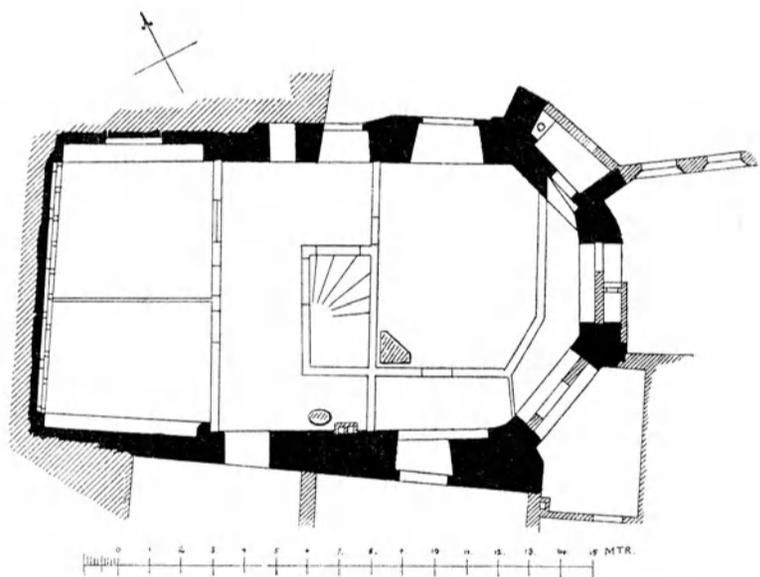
Grundriss der St. Katharinenklosterkirche nach A. Reinberg.
